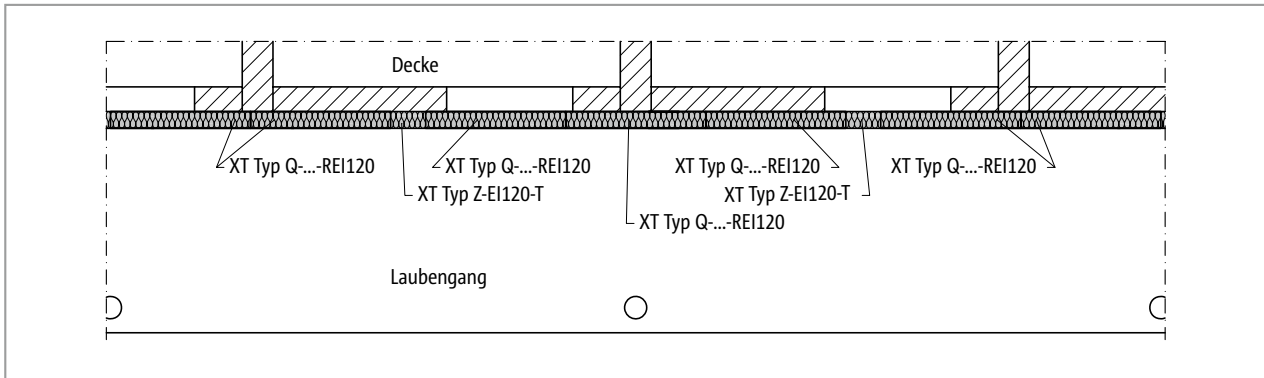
Schöck Isokorb® XT Typ Q...-REI120, Typ Z-EI120-T: Laubengang raumabschließend
